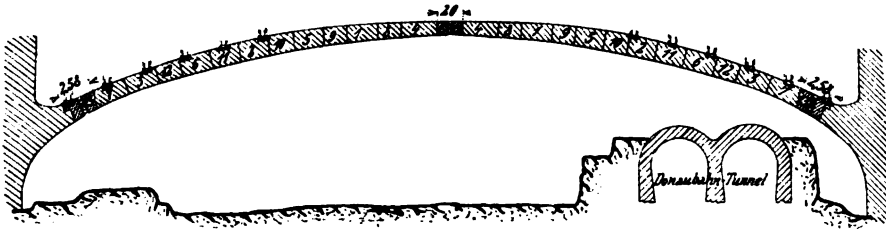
Betonierungsschema des Bogens der Wallstraßenbrücke.
